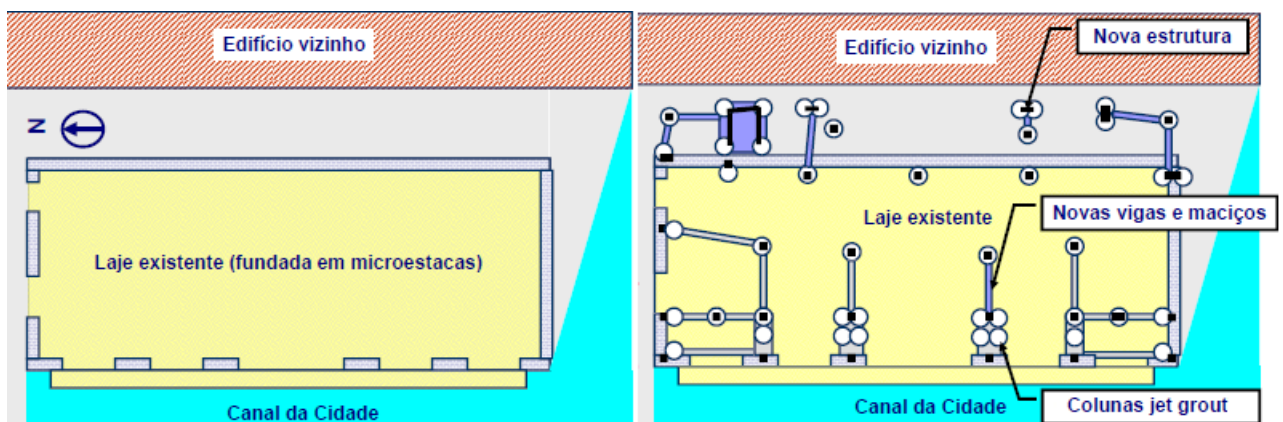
Esquema em planta da laje de fundação: a) original; b) após o reforço [63]
